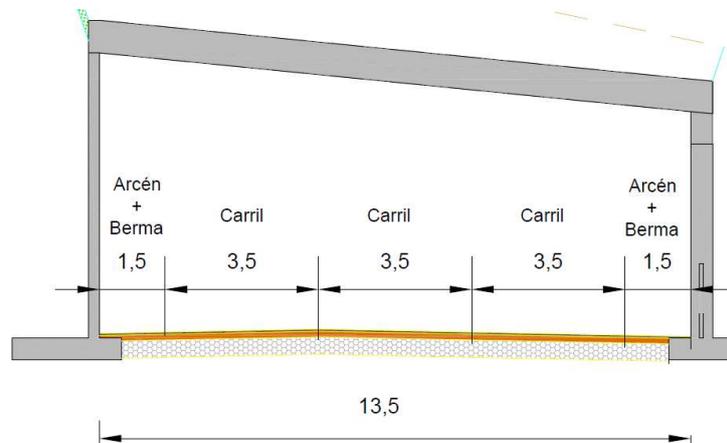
SECCIÓN TRANSVERSAL ESTRUCTURA ANTIALUDES
